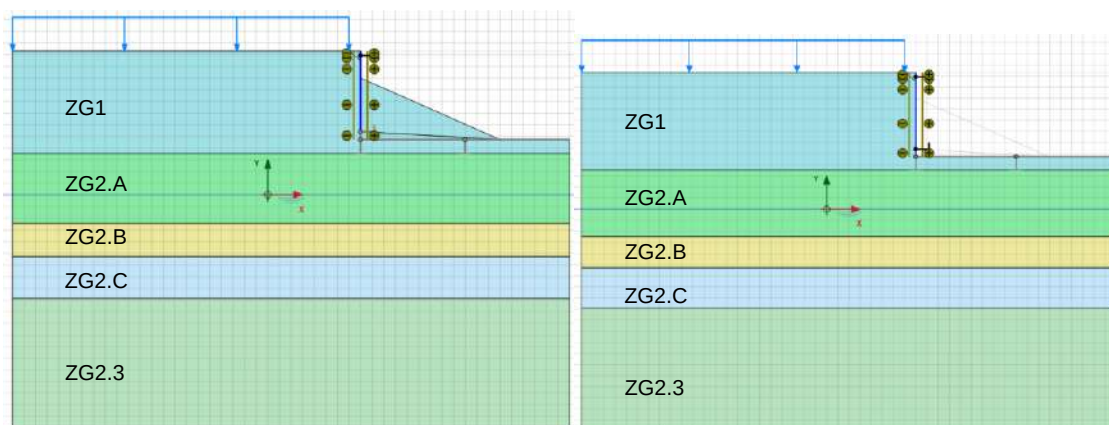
Modelo de cálculo da estrutura de contenção do tipo Berlim definitivo travada provisoriamente com escoras metálicas horizontais
